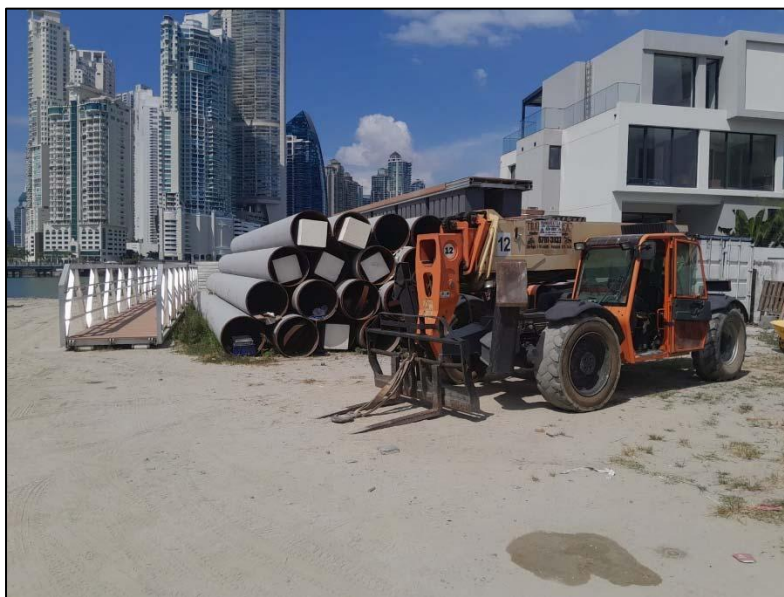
Área donde se desarrollará el embarcadero privado.
